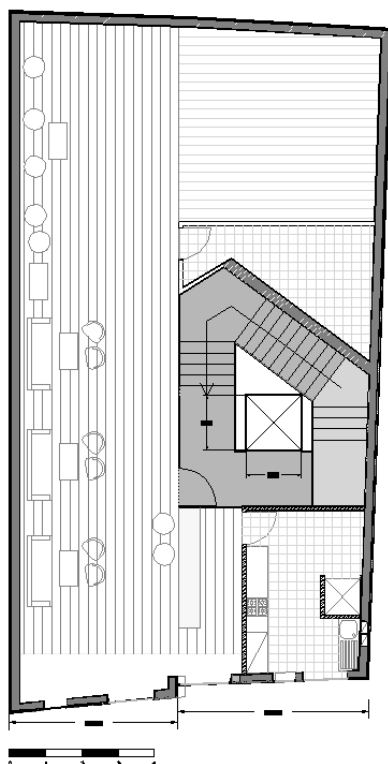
Planta Piso 2, escala 1/50, Autocad
